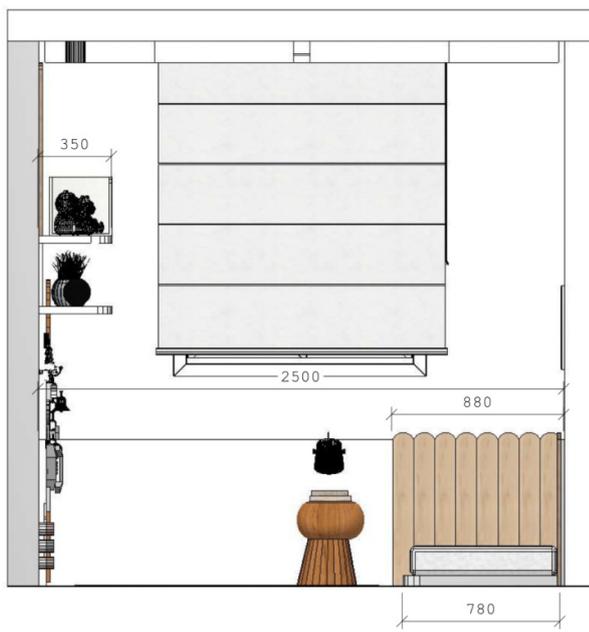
Detalhamento imagem 5. Fonte: Autora.
